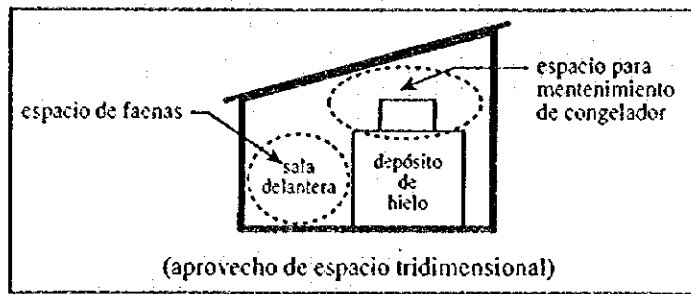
Sala de Fabricador de Hielo de Secciones
